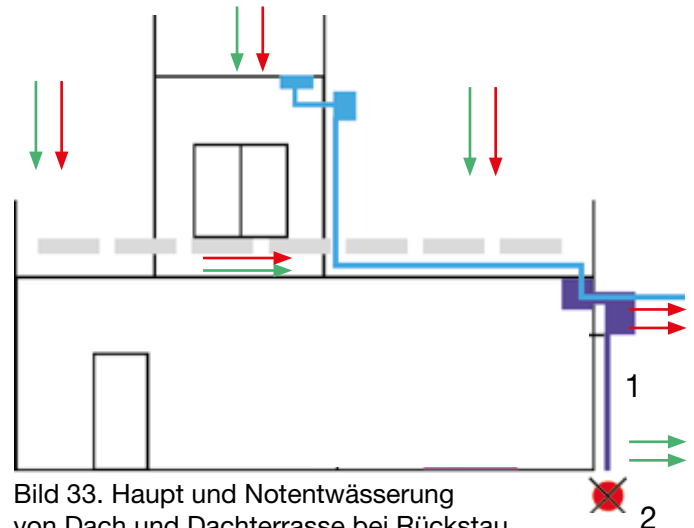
Haupt- und Notentwässerung von Dach und Dachterrasse bei Rückstau aus der Grundleitung
